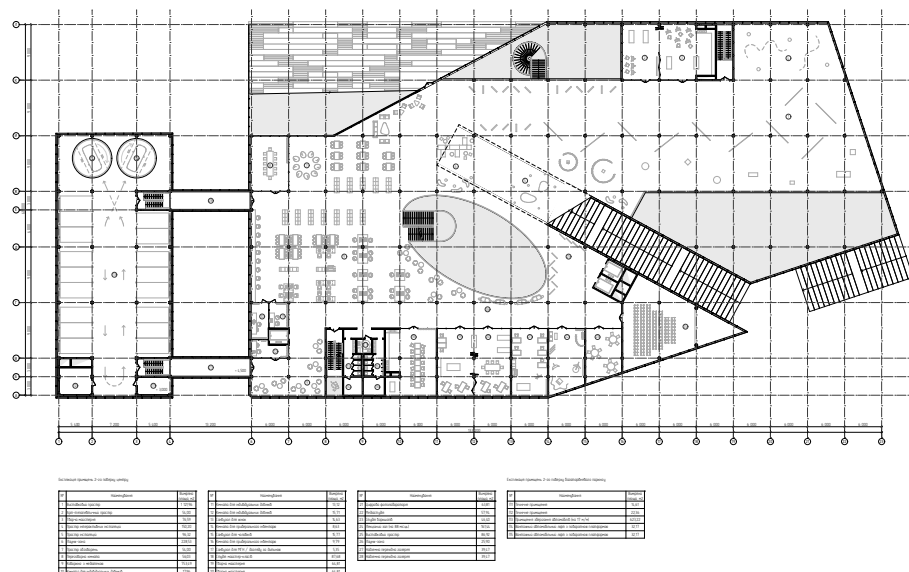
План 2-го поверху на відм. +4,500
